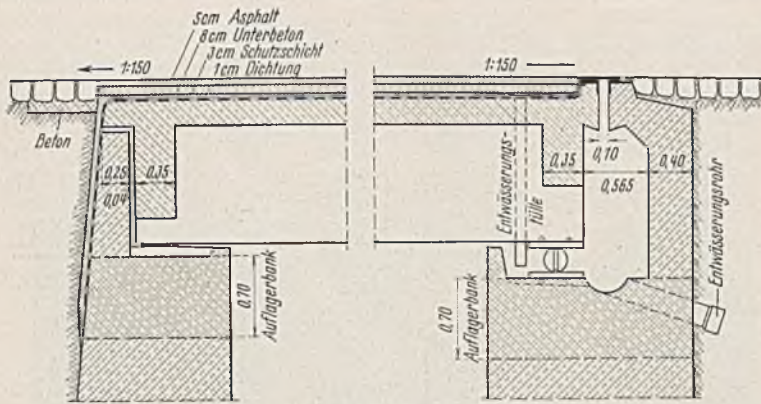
Ausbildung der Brücke am festen und beweglichen Lager.
